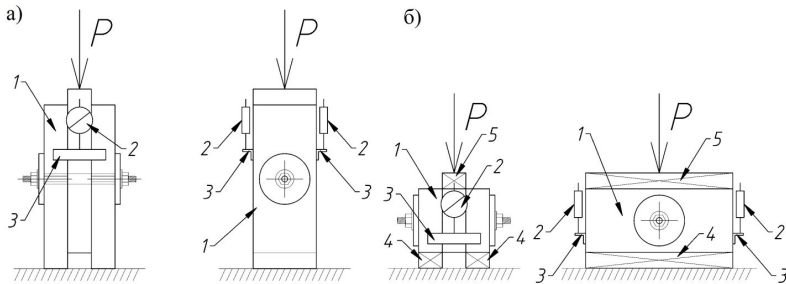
Схемы испытания образцов: а) вдоль волокон б) поперек волокон; 1 – испытательный образец; 2 – индикатор перемещений; 3 – опорный столик индикатора; 4 – нижняя подкладка; 5 – верхняя накладка
